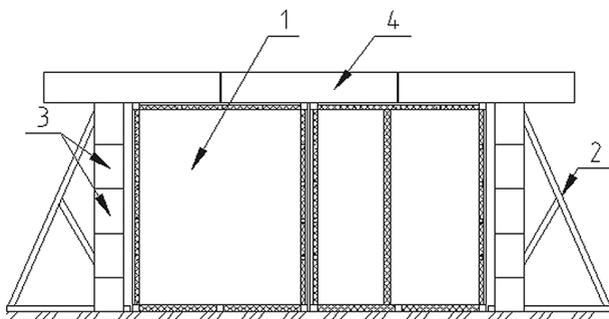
Поперечное сечение убежища, состоящего из 2-х блок-модулей: 1 — блок-модуль; 2 — контрфорс; 3 — бетонные блоки усиления стен; 4 — бетонные блоки усиления перекрытия
